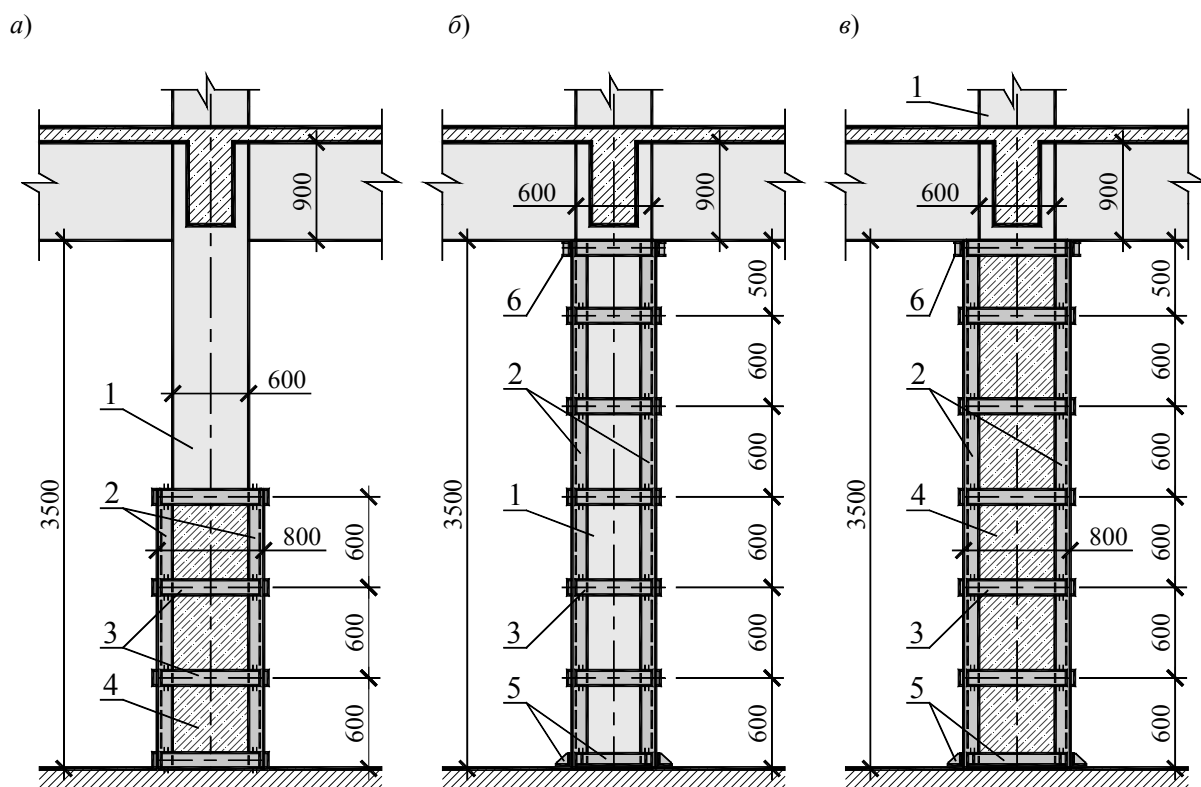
Технические решения по восстановлению и усилению железобетонных колонн: а – местное усиление железобетонной колонны стальной обоймой с обетонированием; б – усиление железобетонной колонны стальной обоймой; в – усиление железобетонной колонны стальной обоймой с обетонированием; 1 – усиливаемая колонна; 2 – продольные уголки стальной обоймы; 3 – поперечные планки стальной обоймы; 4 – бетонная обойма; 5 – опорный уголок башмака; 6 – швеллер
